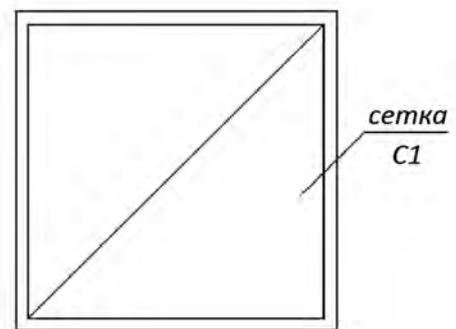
Упрощенное изображение сетки армирования, расположенной у подошвы монолитного столбчатого фундамента
